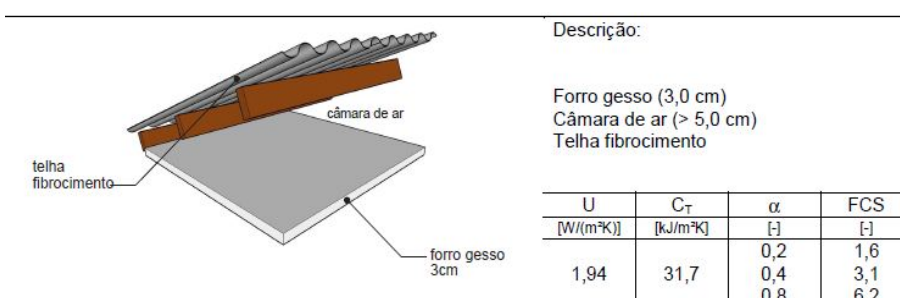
Telhado de fibrocimento com forro de gesso (LabEEE 2010)
